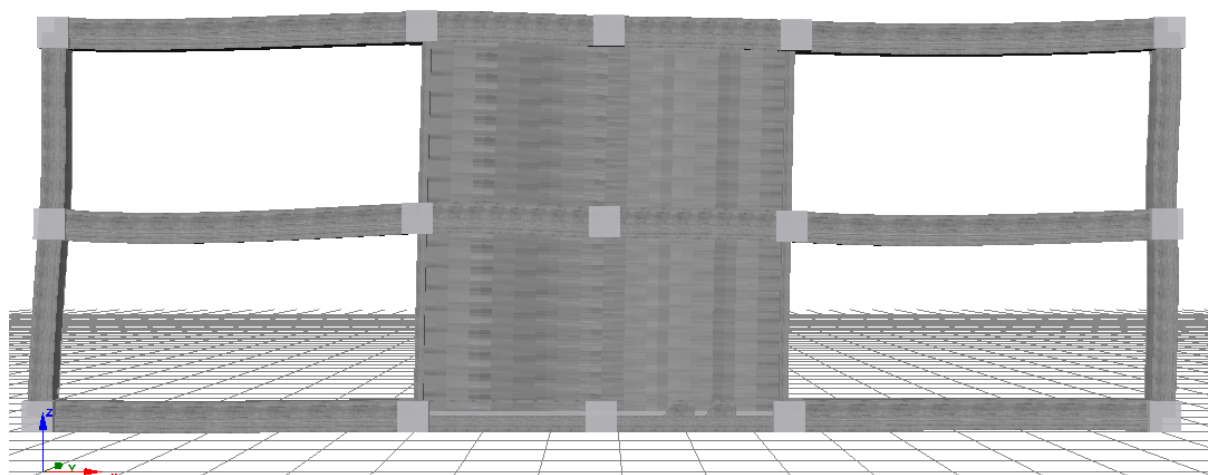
Deformada da estrutura reforçada com a parede resistente de betão armado.
